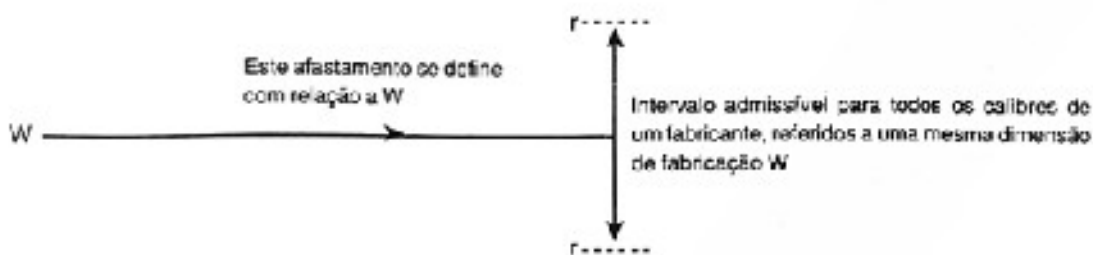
Afastamento de r com relação à dimensão de fabricação W.
